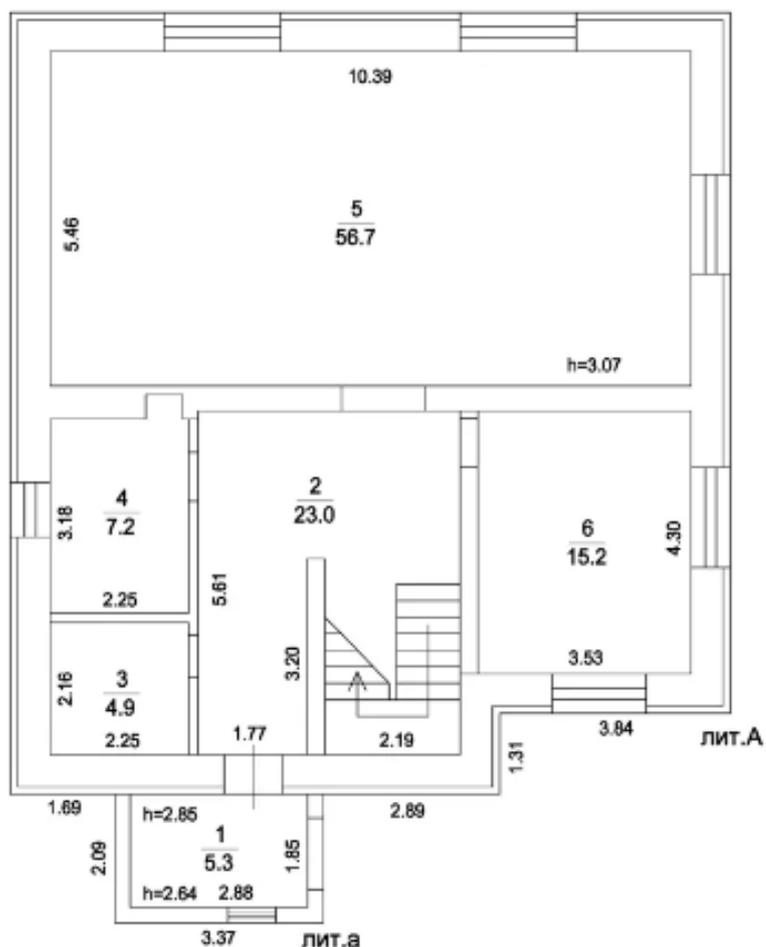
Образец оформления кадастрового плана здания 1-го этажа
